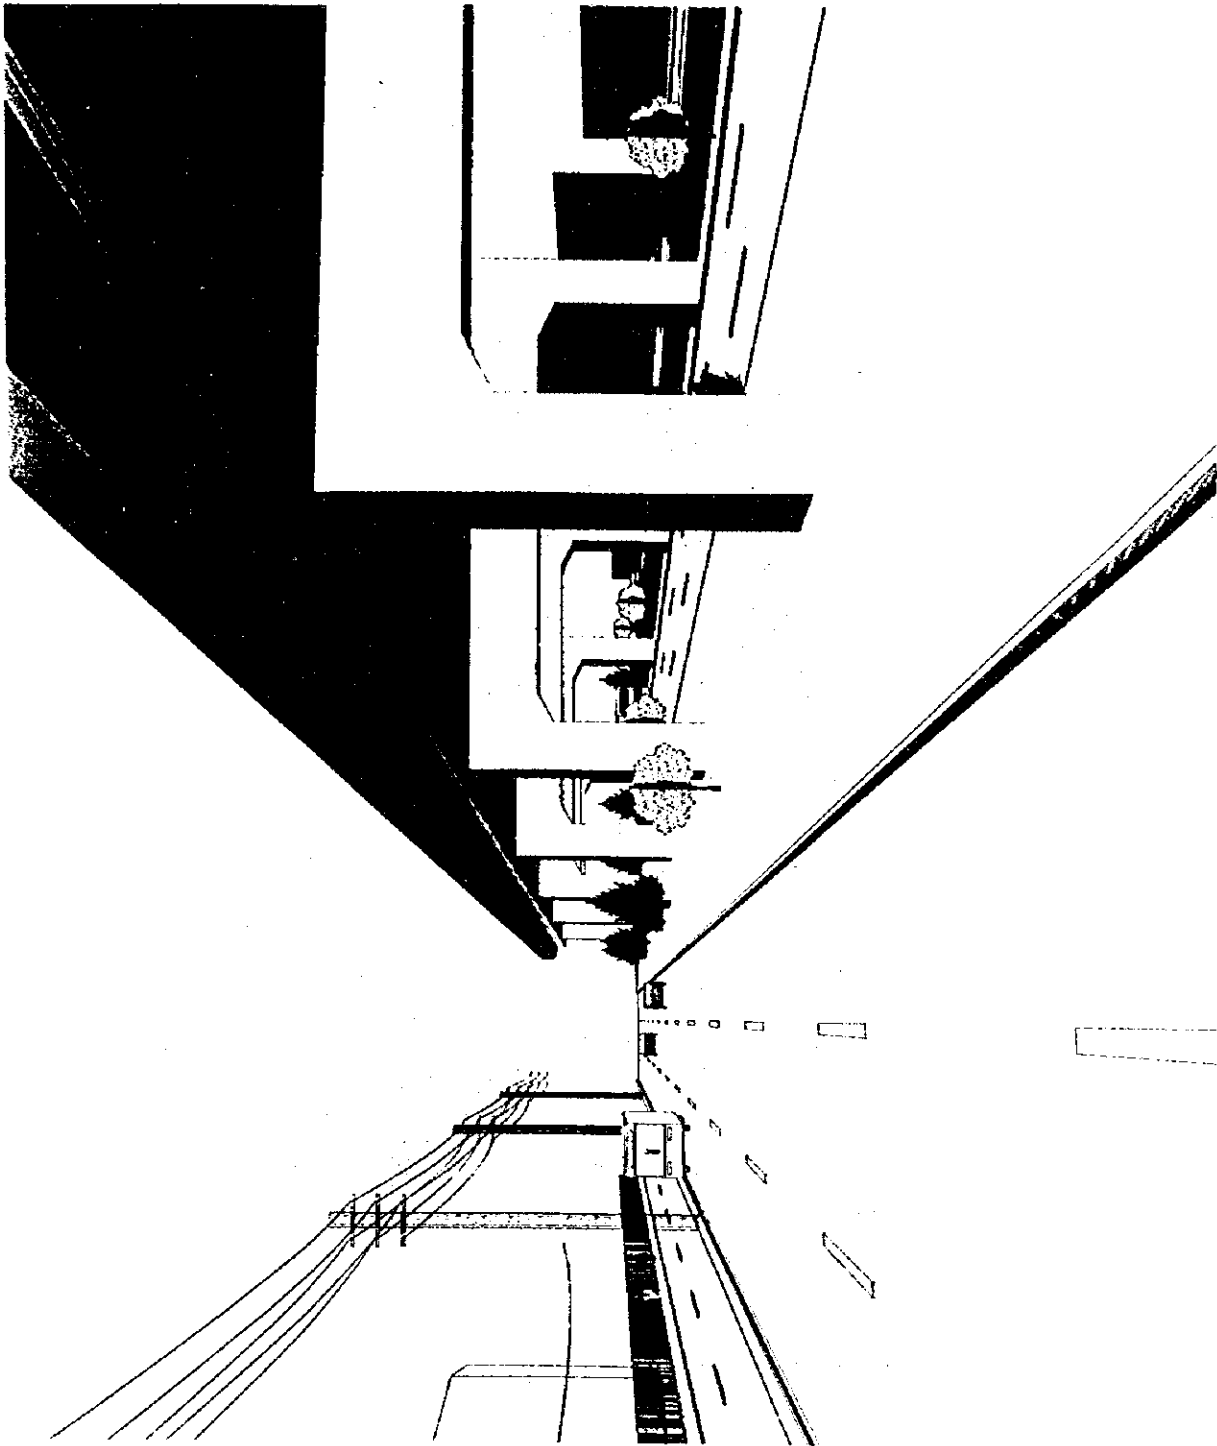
Plano tridimensional de la Alternativa B en la Avenida Quito (1)
